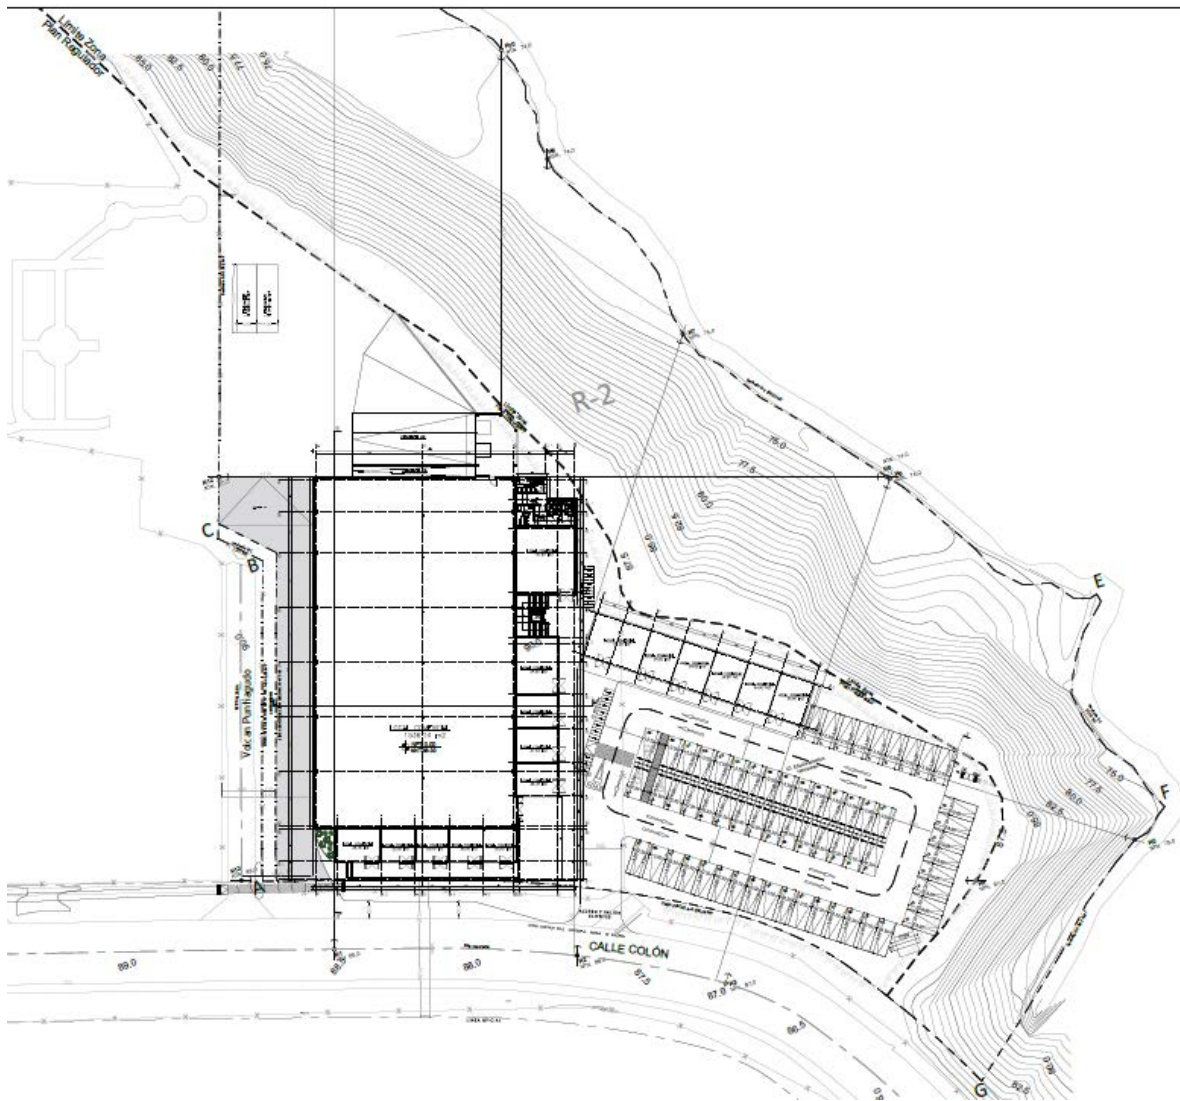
Plano Layout de centro Comercial Rosa Emilia.
